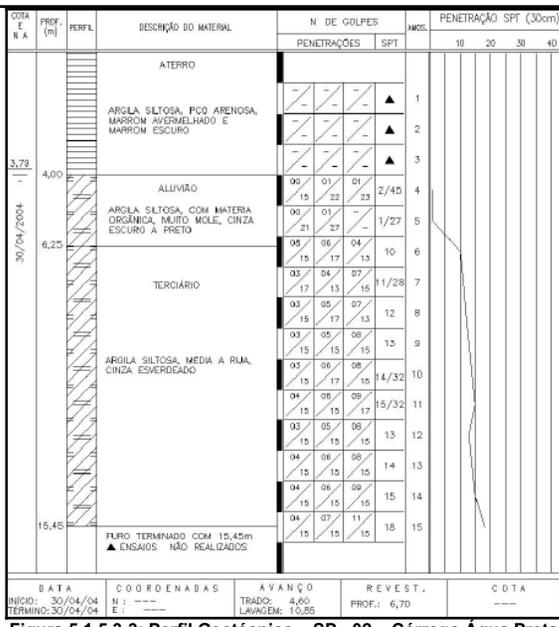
Perfil Geotécnico – SP - 02 – Córrego Água Preta
